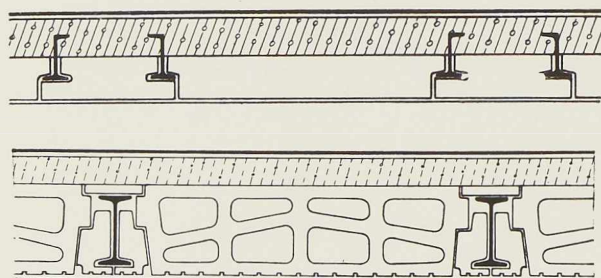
Hourdis en béton coulé sur plaques de plâtre (au-dessus) et en béton de bims (en dessous).
